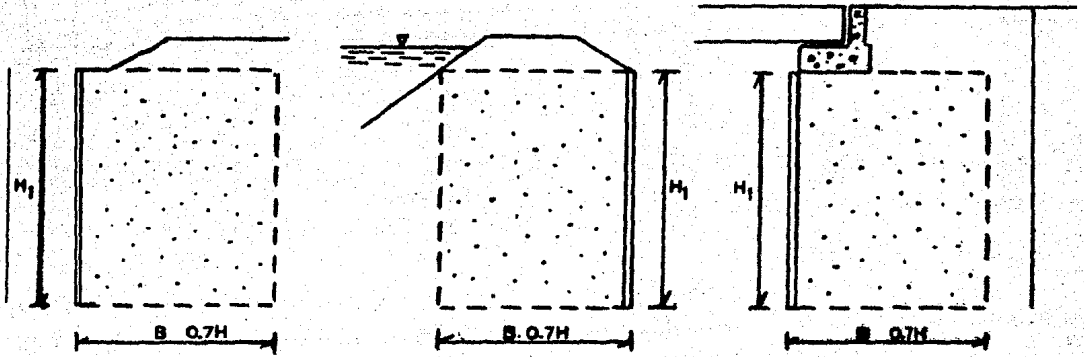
Prediseño de una estructura de Tierra Armada.
